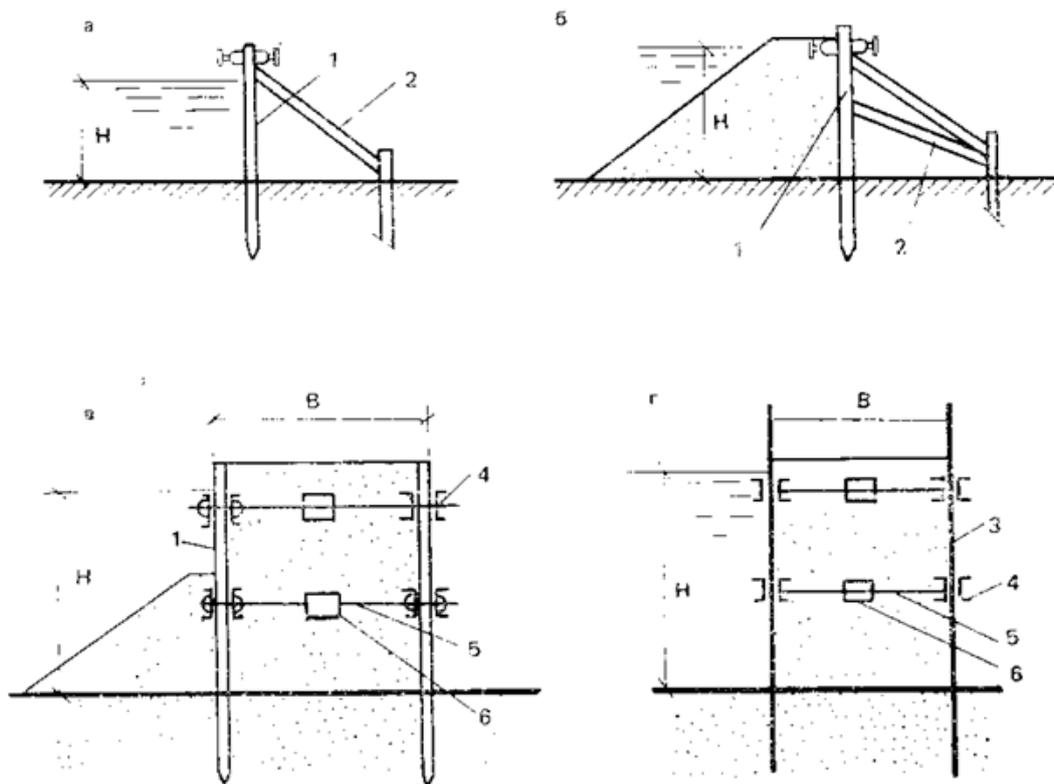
Шпунтовые перемычки: а – однорядная без присыпки; б – однорядная с присыпкой; в – двухрядная (деревянная) с присыпкой; г – двухрядная (металлическая) без присыпки; 1 – шпунт деревянный; 2 – подкосы; 3 – шпунт металлический; 4 – продольные крепления; 5 – поперечные стяжки; 6 – стяжные муфты
